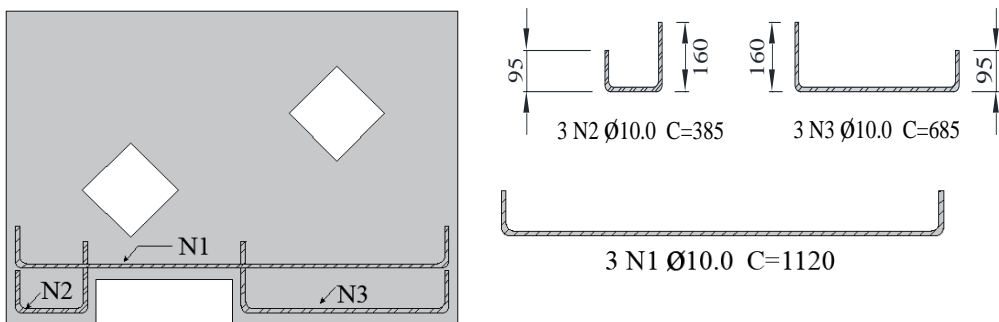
Detalhamento das armaduras DB2-H2-U-A (dimensões mm)
